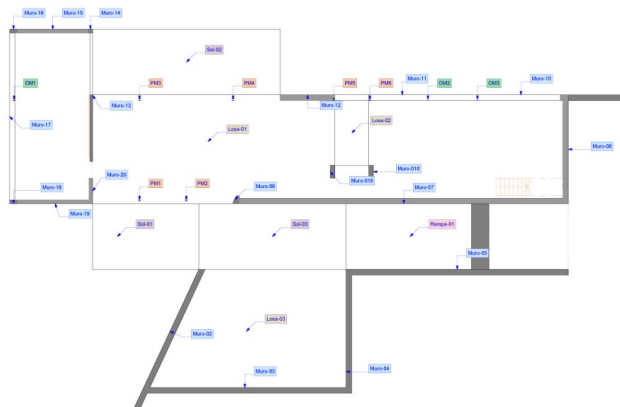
Planta filtrada con etiquetas identificativas en los elementos del sistema estructural.
